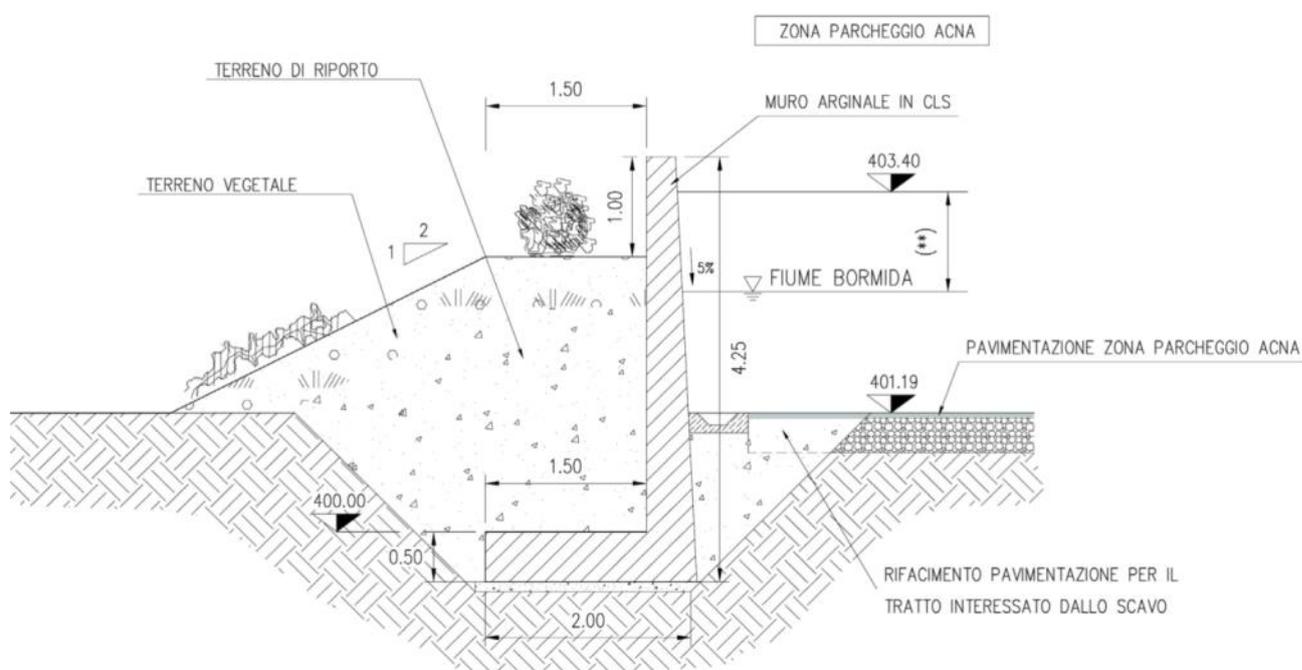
Sezione tipo della dell'opera di confinamento arginale – Tipologia 7
